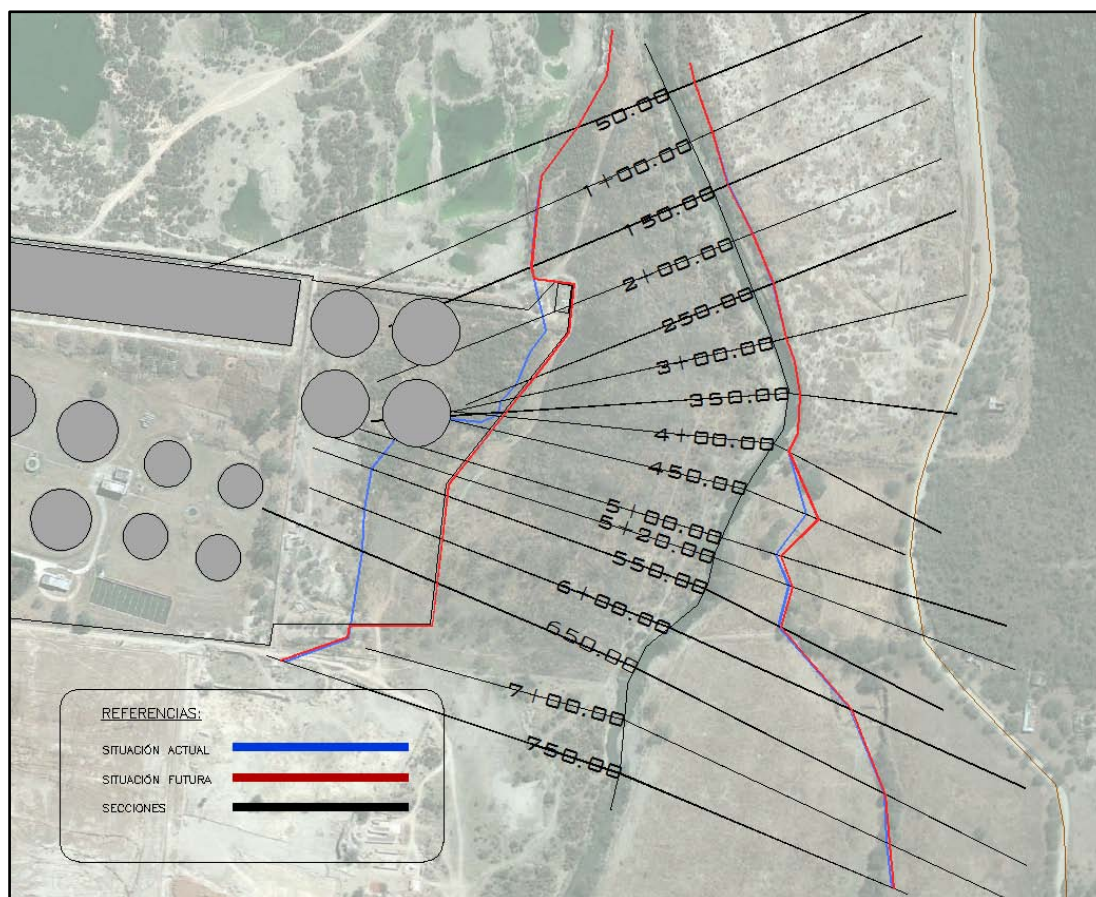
Ubicación del perfil longitudinal y secciones transversales.
